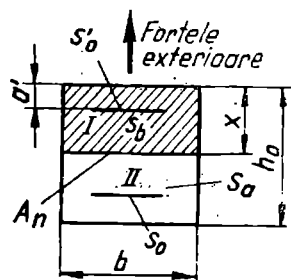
Solicitățile într-o secțiune a unui stîlp de beton armat.
